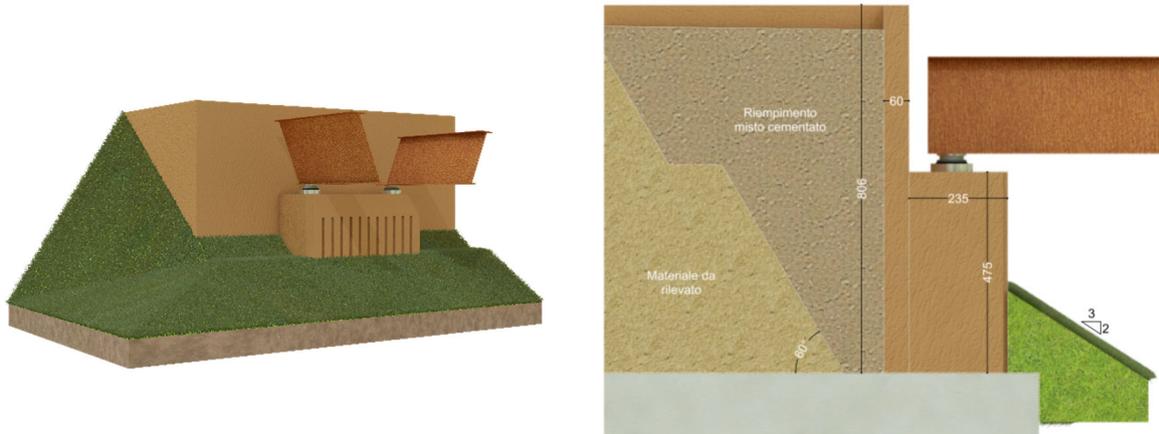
Modello 3d tipologico della spalla e sezione tipologica della spalle
